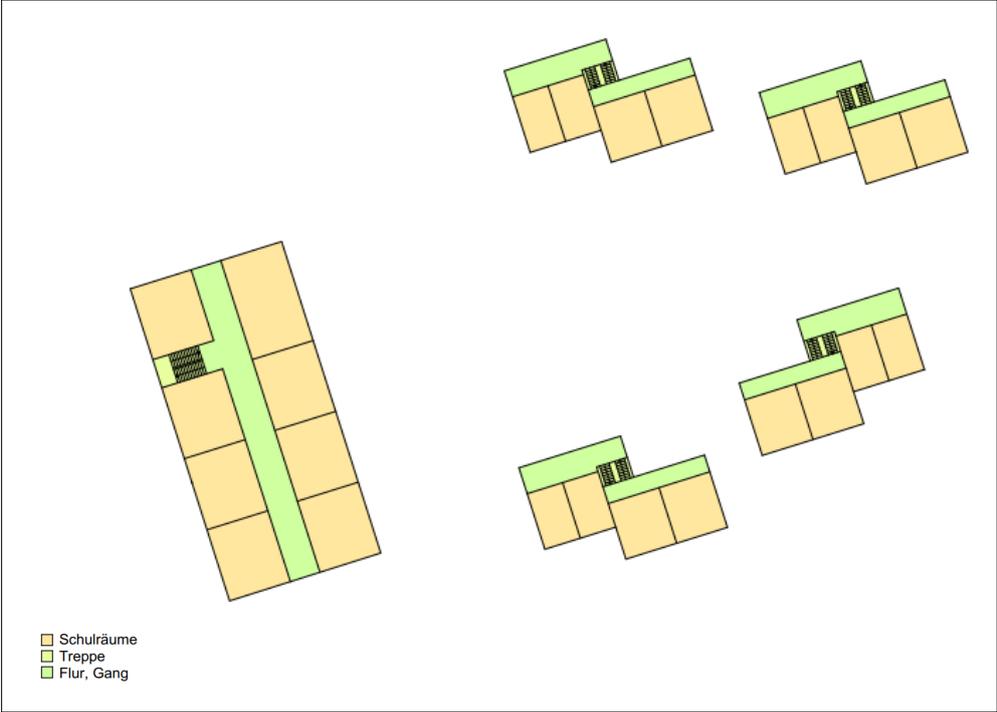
Schematische Darstellung einer Pavillonschule mit zweistöckigen Pavillons.
